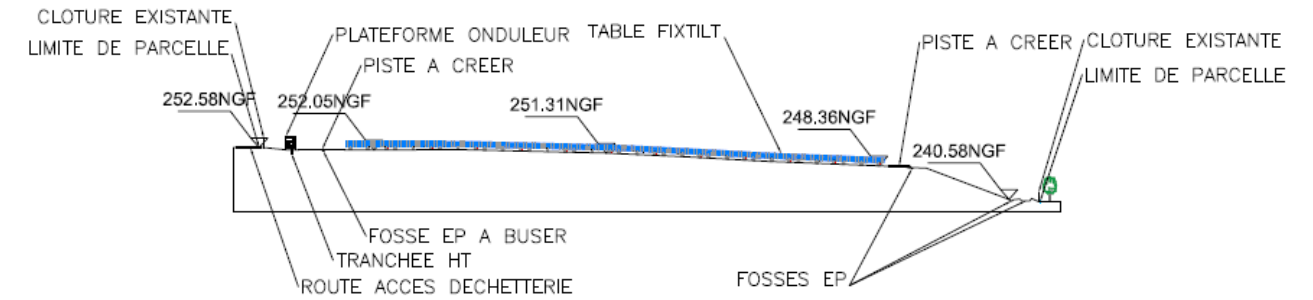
Coupe nord-sud de l'installation des panneaux sur le site
